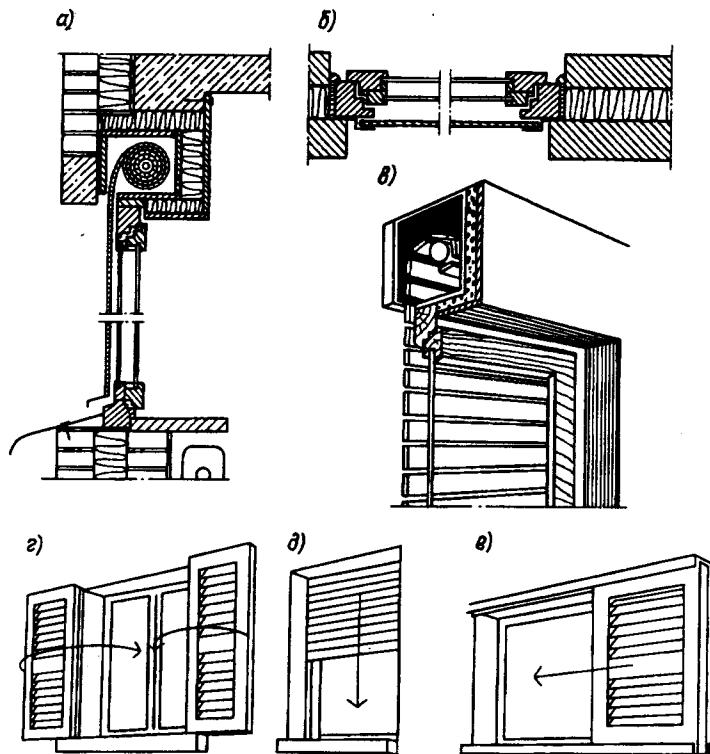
Окна со сворачивающимися экранами (а — вертикальный разрез; б — горизонтальный разрез; в — аксонометрия), закрывающимися ставнями (д); опускающимися жалюзиями (д) и задвигающимися ставнями (е)
